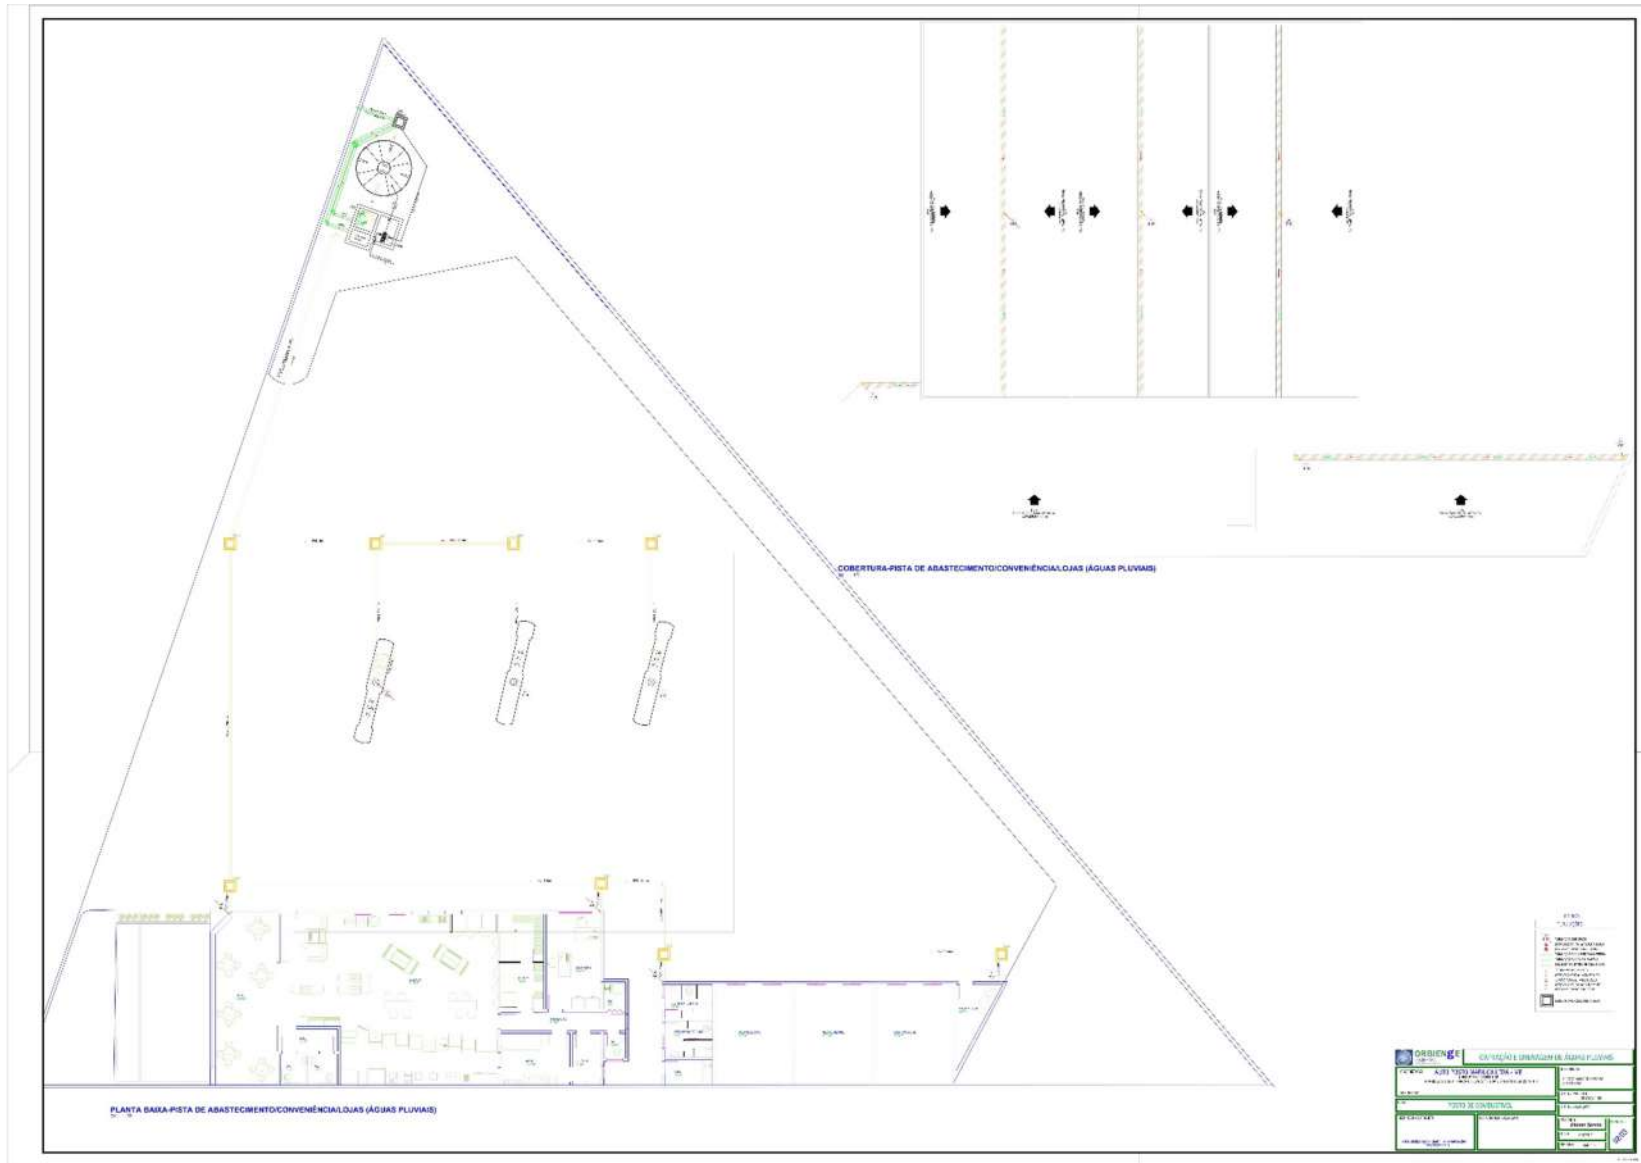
Projeto de drenagem de águas pluviais – Planta baixa.
